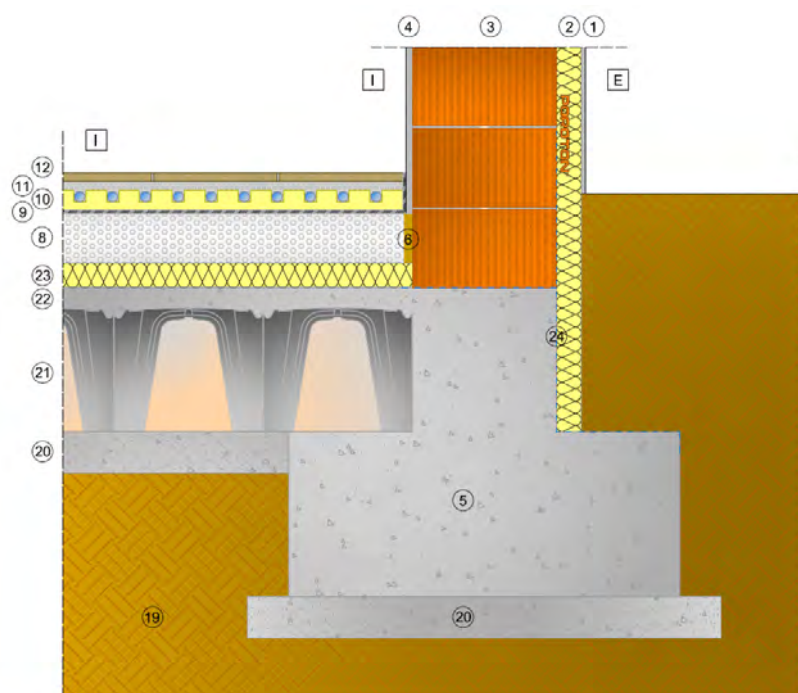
Dettaglio costruttivo del ponte termico dell'attacco parete-fondazione con vespaio aerato su terreno (PT8).
